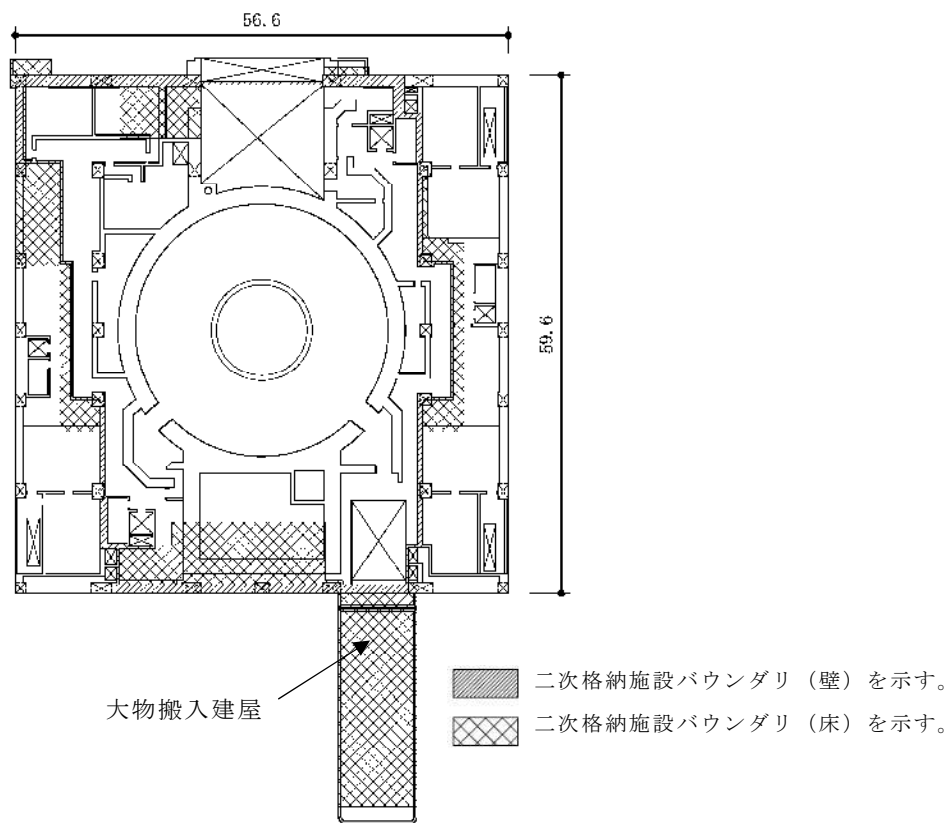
原子炉建屋原子炉区域（二次格納施設）の範囲の平面図（単位：m）
